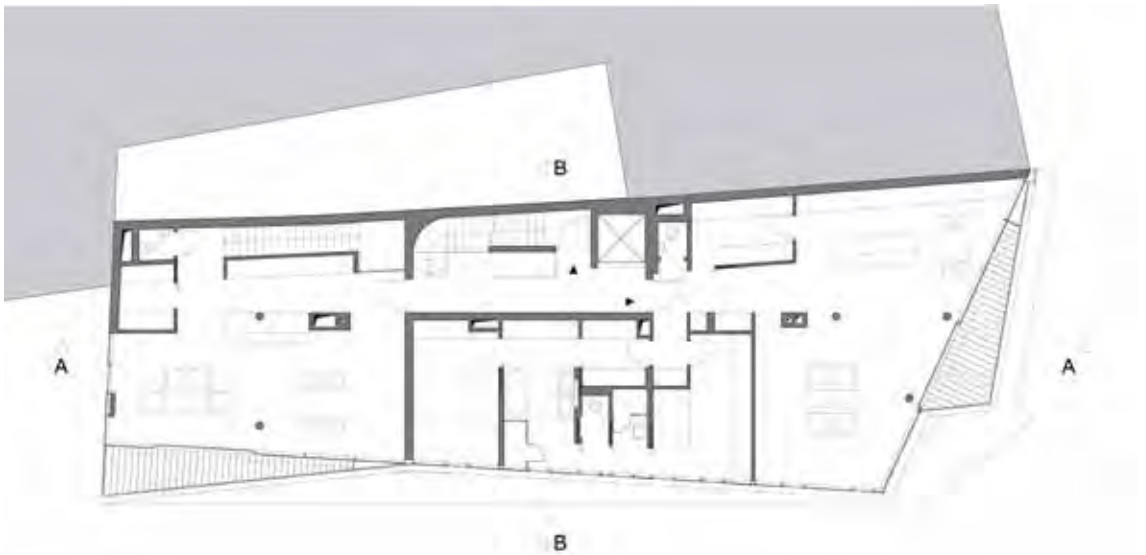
Grundriss 2.DG © Josef Weicheberger Architects
